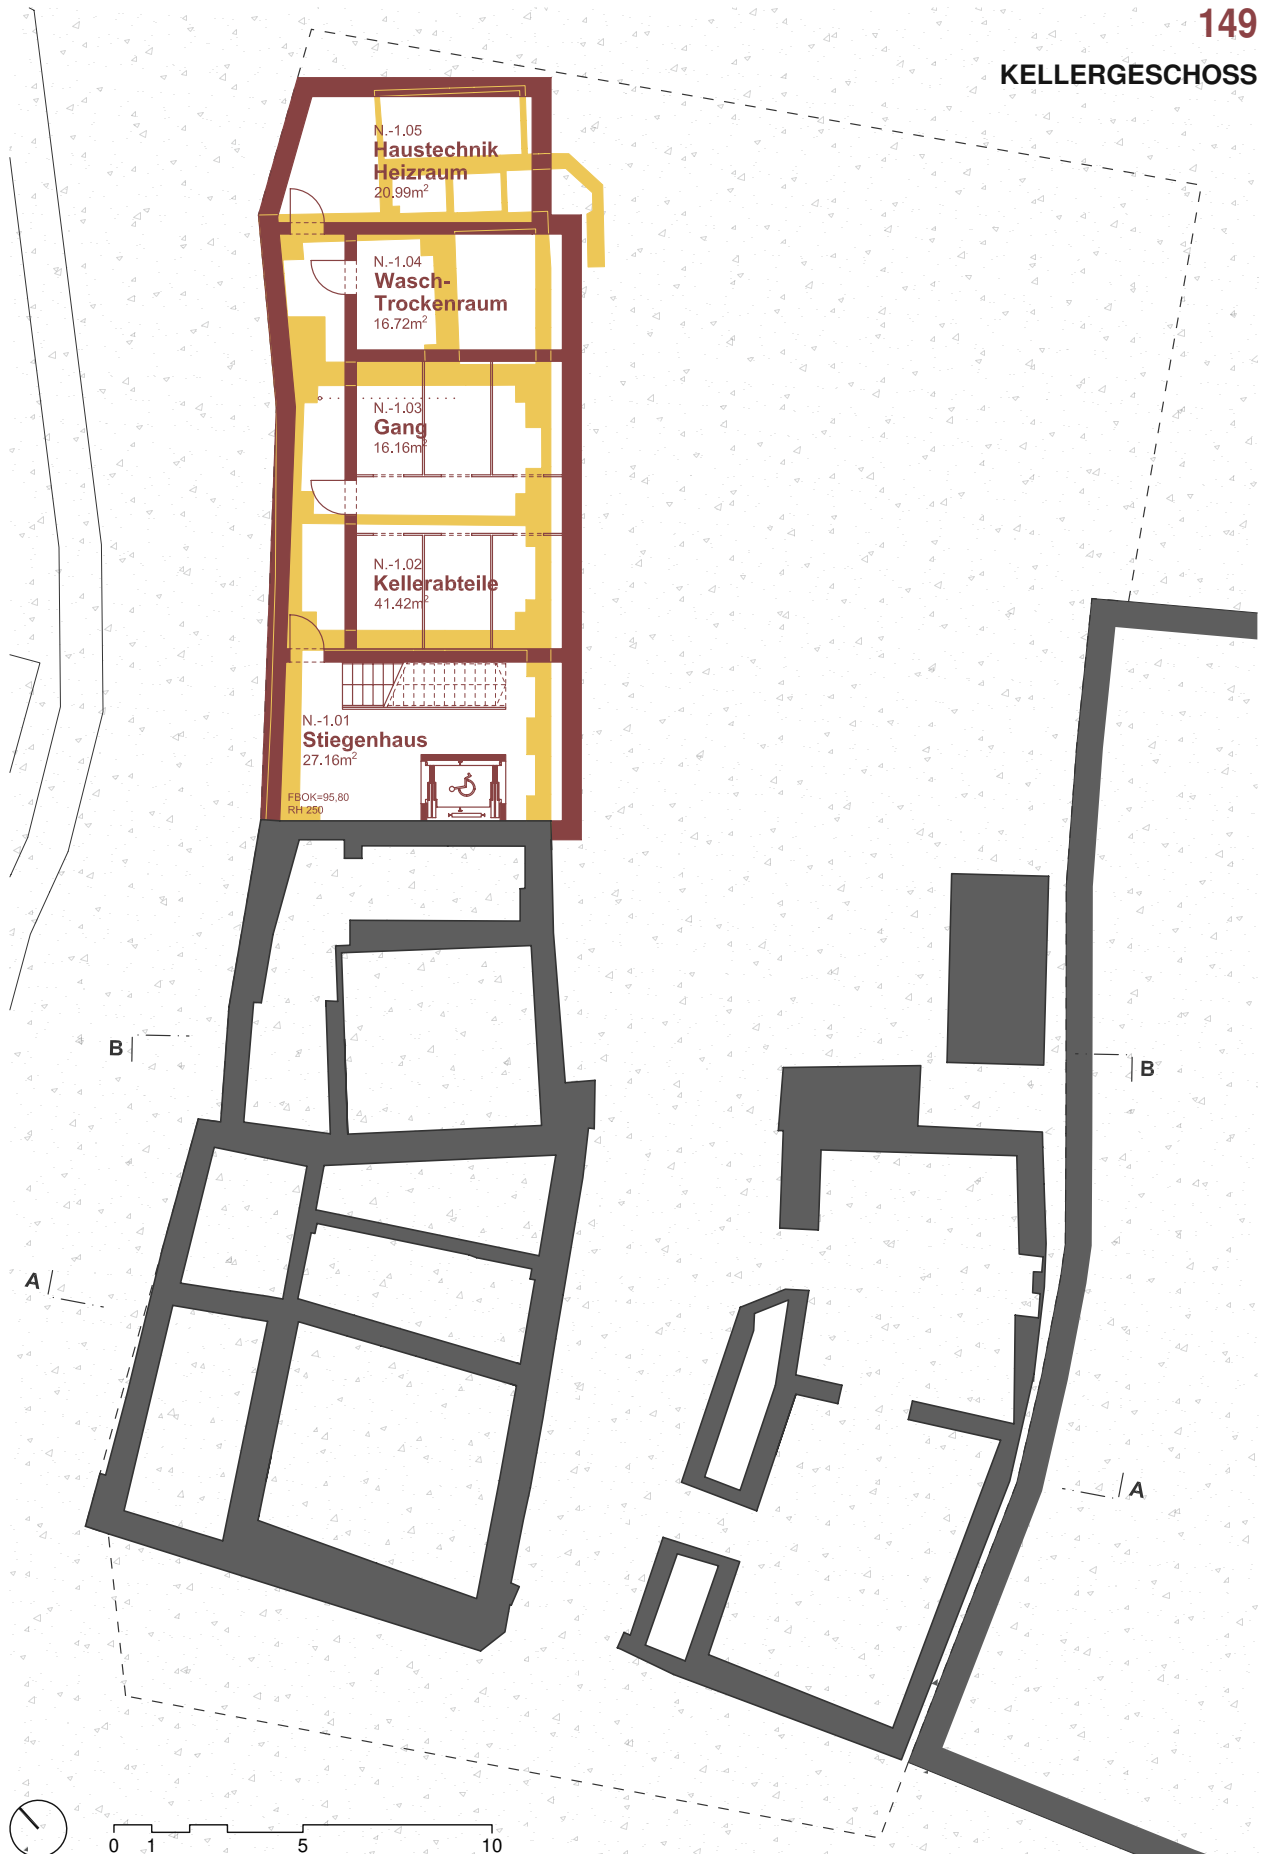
Bauliche Eingriffe Grundriss Kellergeschoß
